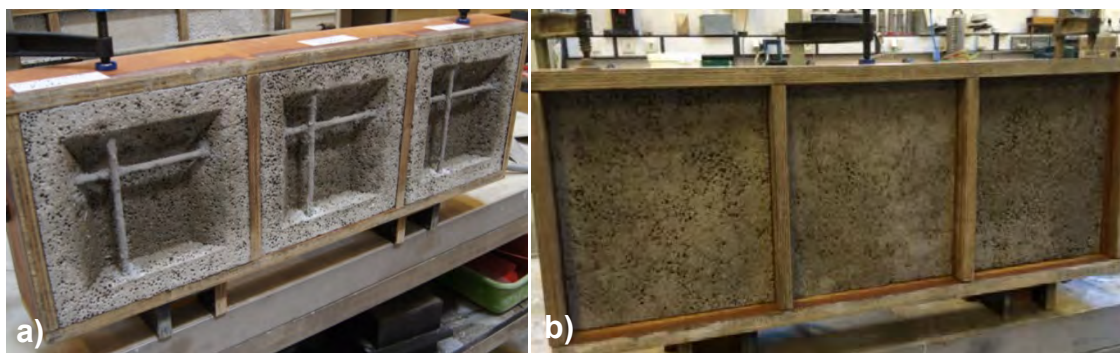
a) bewehrter Prüfkörper b) unbewehrter Prüfkörper
